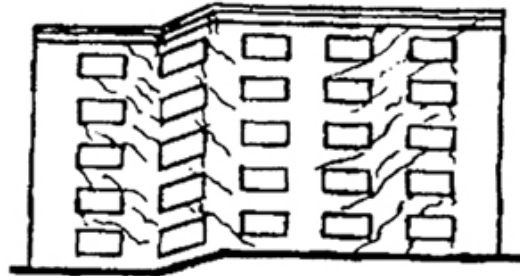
Повреждение стены бескаркасного здания при образовании в основании уступа
